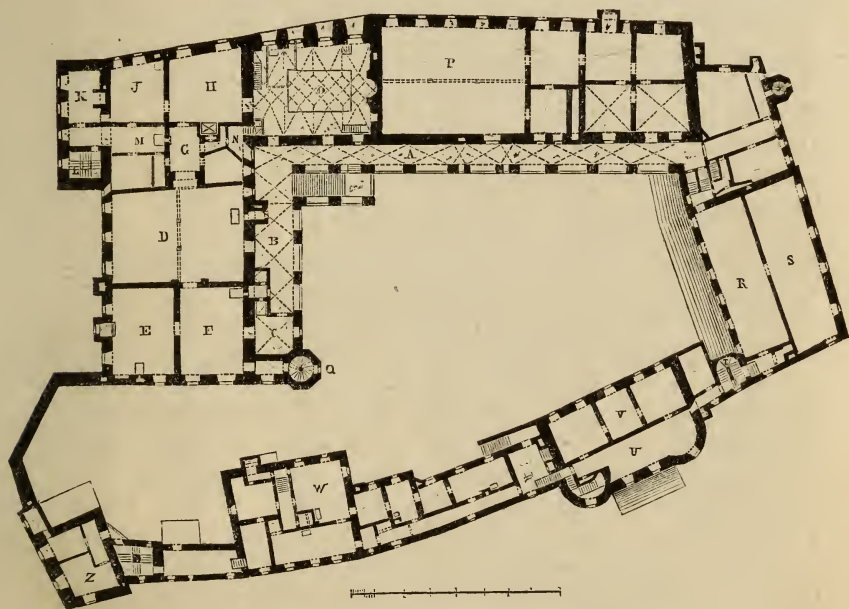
Trausnitz. Grundriss des ersten Stockes.
